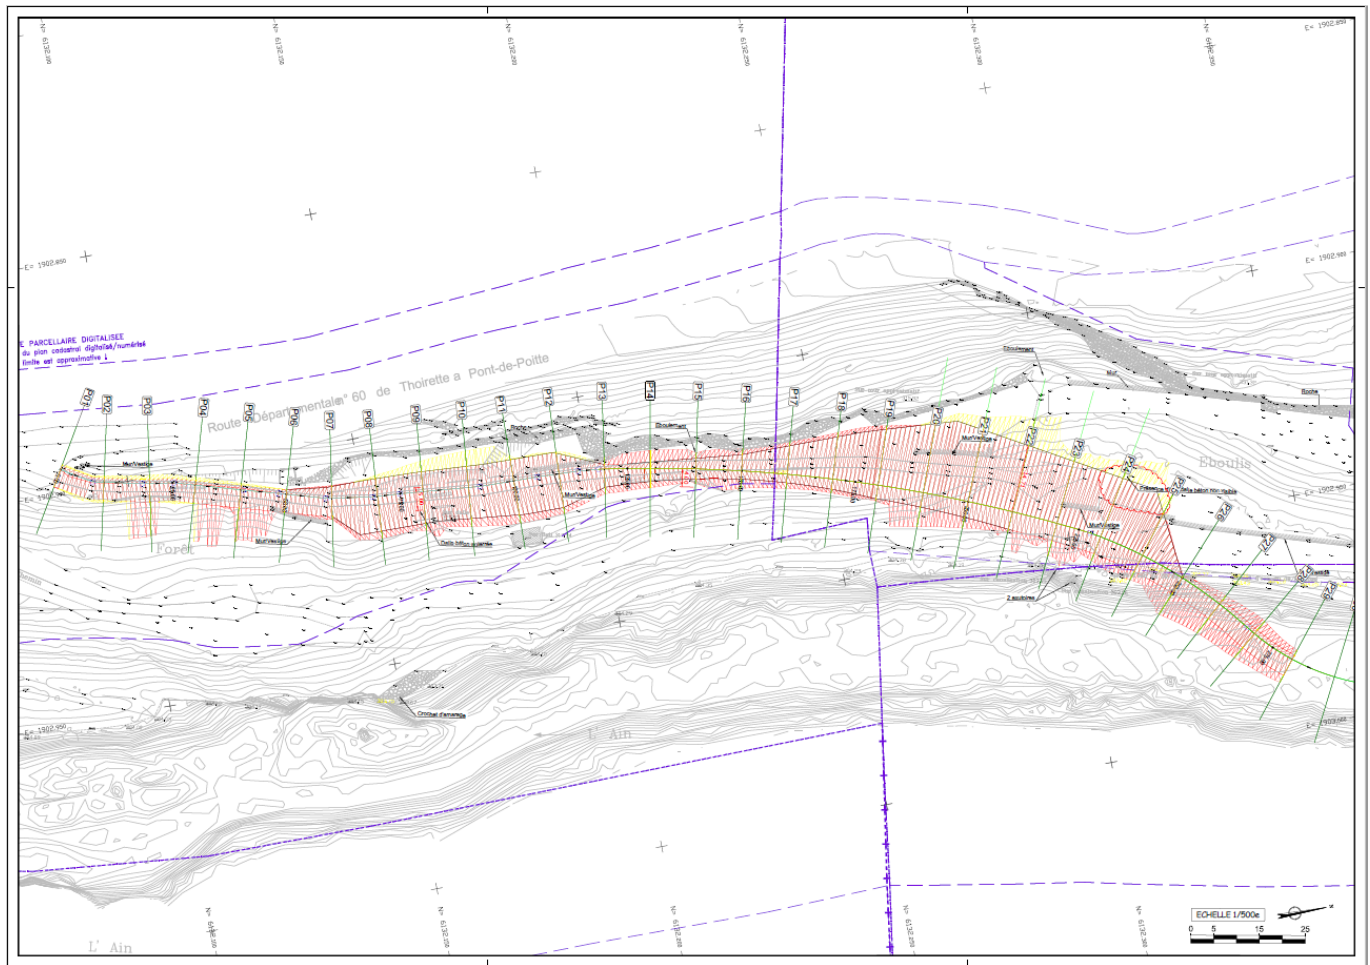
Plan de la piste d'accès et de la zone d'entreposage provisoire des matériaux en aval rive droite du chenal d'évacuation de Saut Mortier
